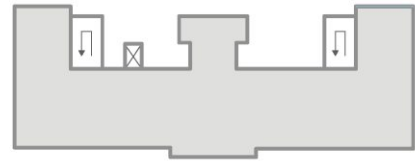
Schema Adaptierung und Erweiterung: Grundriss 1. Obergeschoß.
